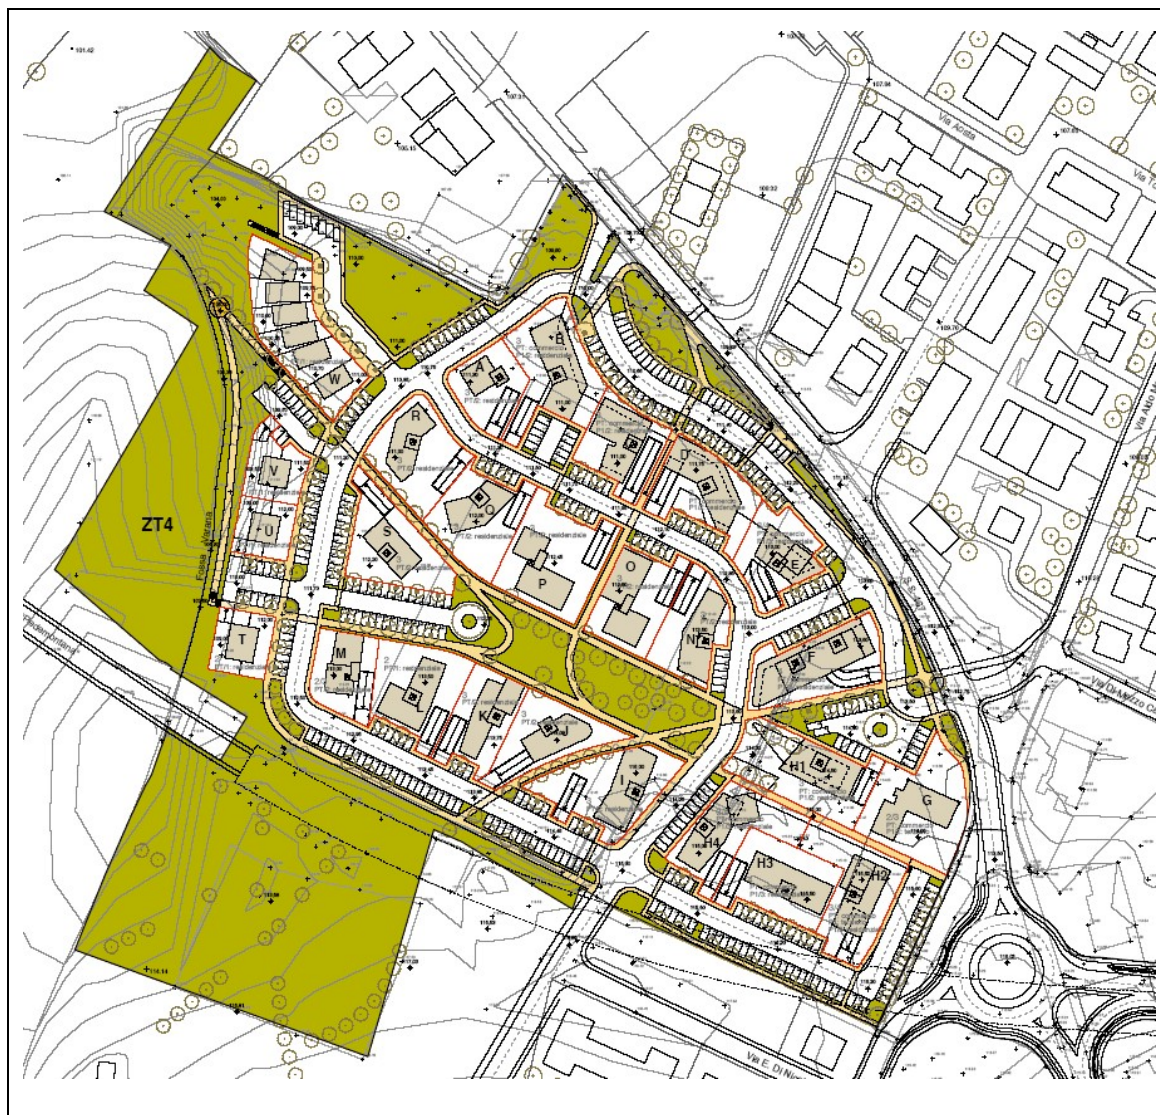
Ipotesi di assetto planivolumetrico del Comparto ZT4. (Studio di Architettura Tiziano Lugli).
